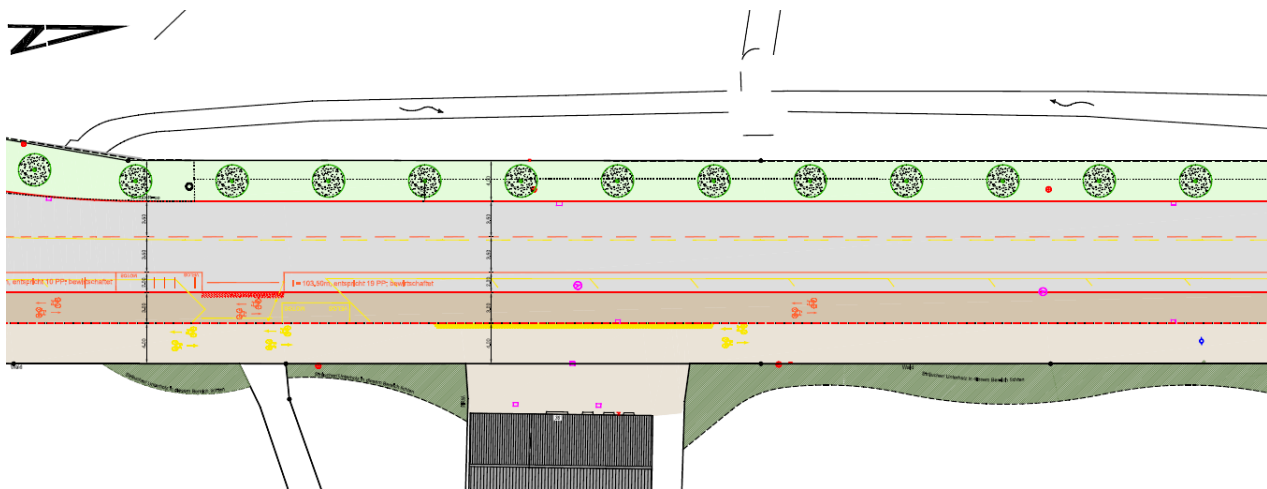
; Projekt – Planausschnitt, Abschnitt B
